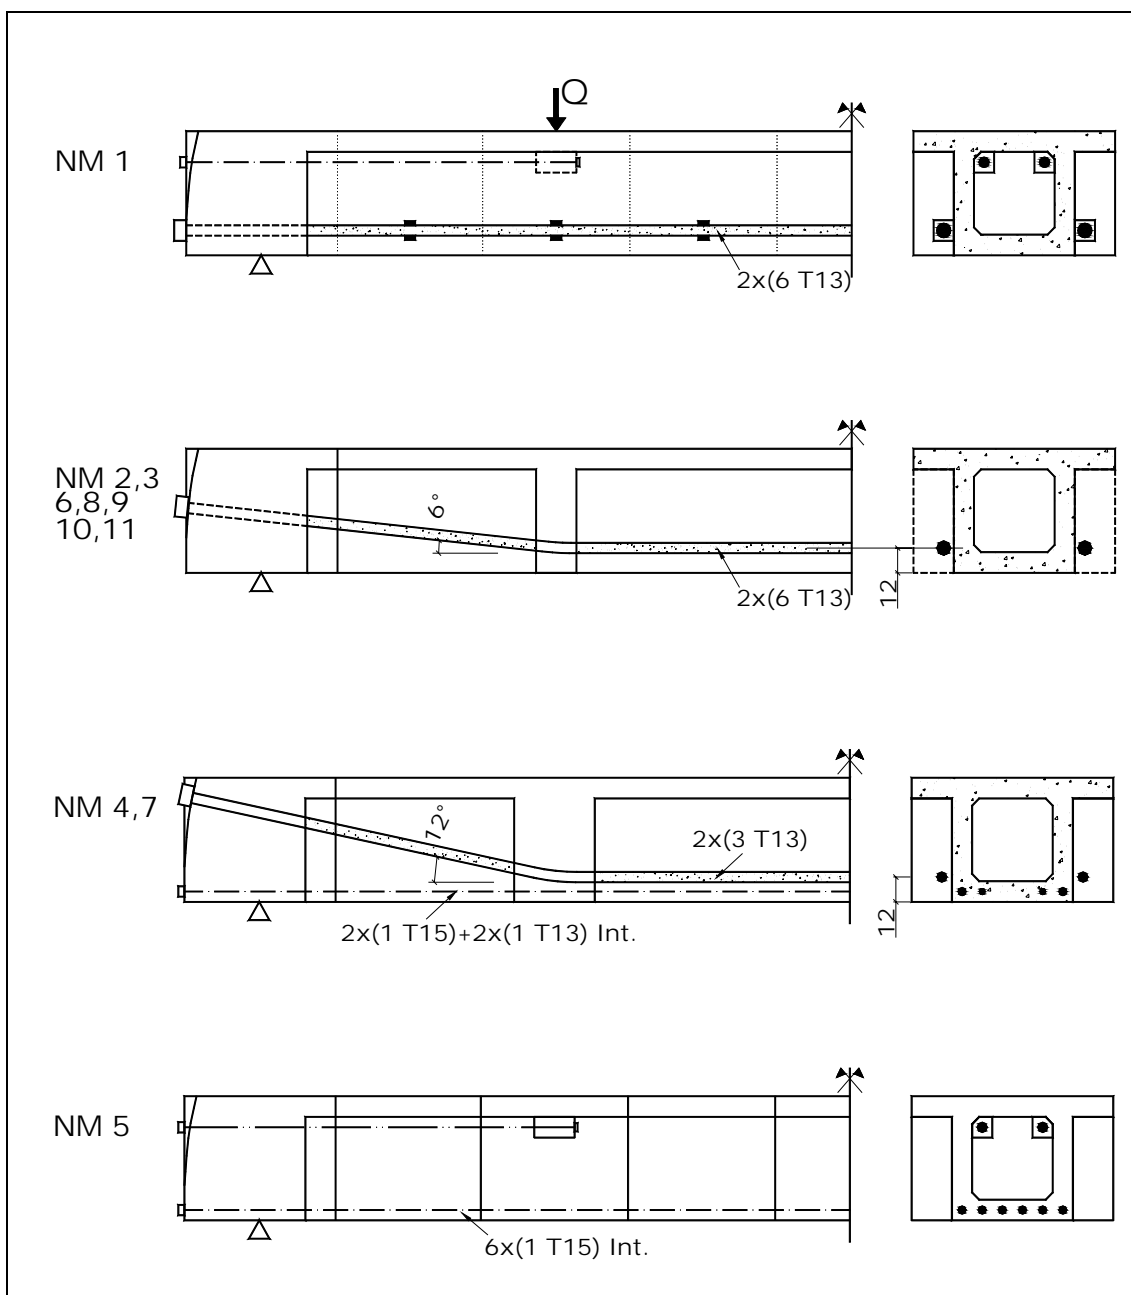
Disposição dos cabos nas vigas ensaiadas
